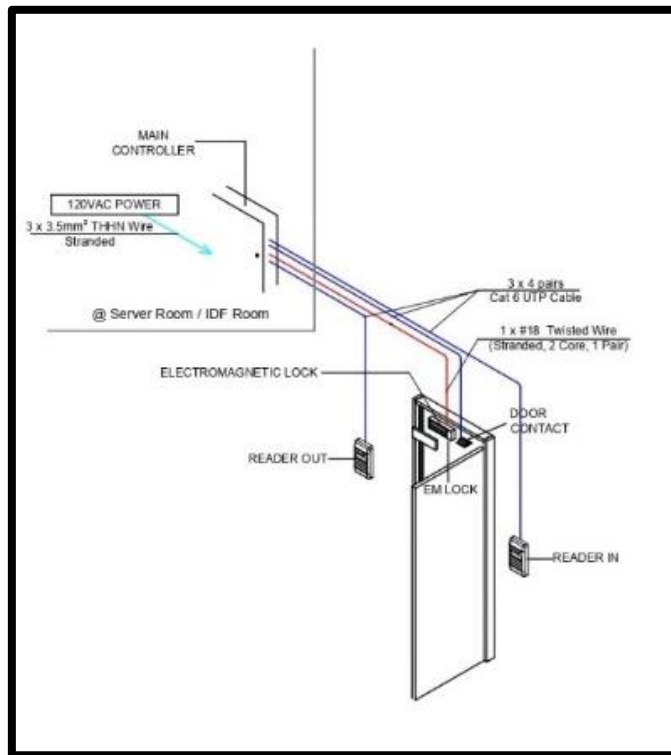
Configuración puertas Control de acceso. (Green Ingeniería, 2019)
